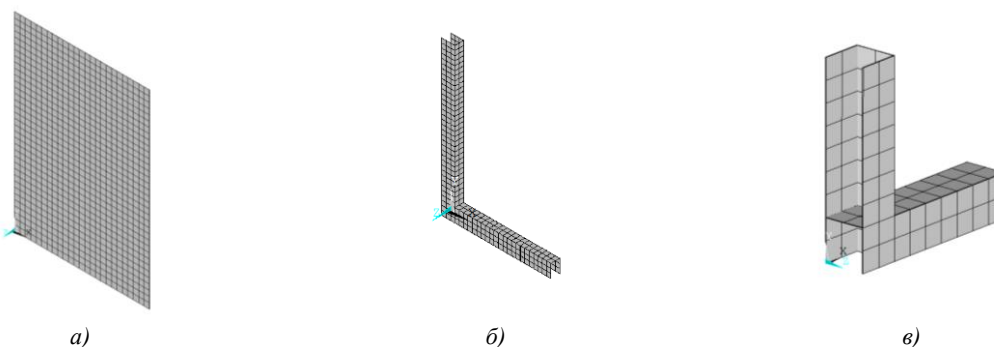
Эквивалентные армирующие слои: а — слой для фоновое армирования (верхнего/нижнего); б — слои армирования ригелей; в — слои армирования капители (рисунок авторов)
